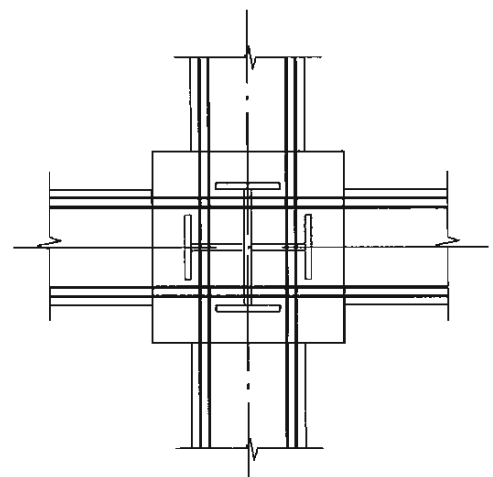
型钢混凝土内型钢梁柱节点穿筋构造
